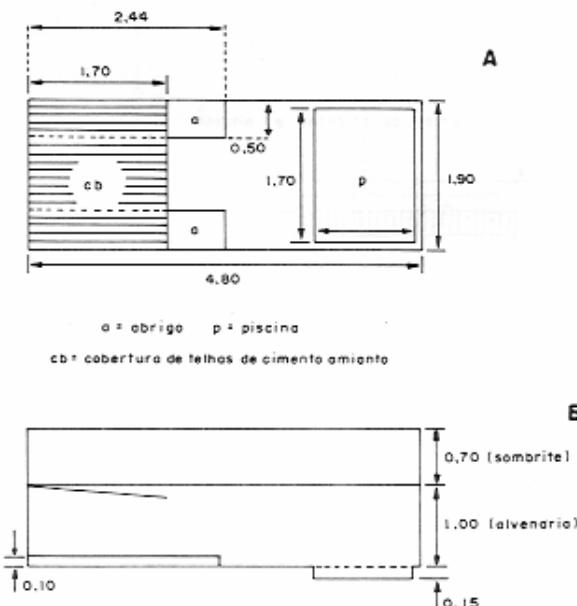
Sistema Confinamento: Planta baixa (A) e corte longitudinal do Confinamento (B) (medidas em metro)
